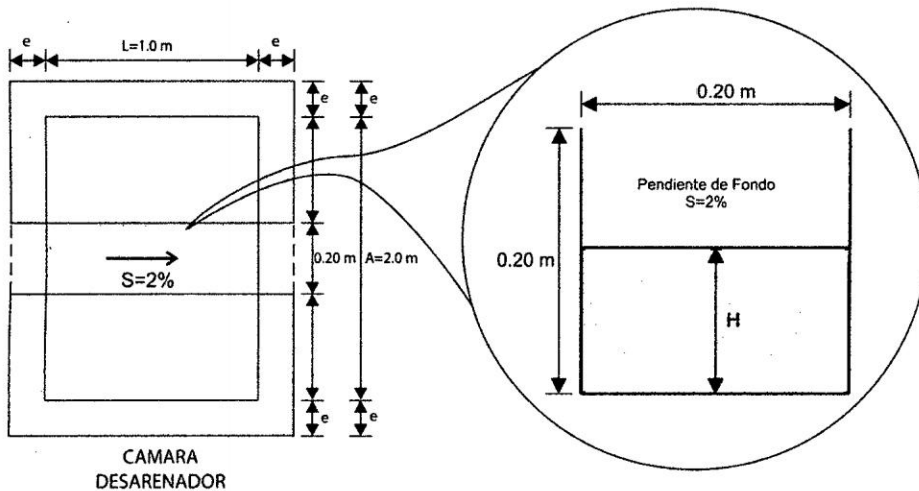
Vista en planta y Sección final de la cámara Desarenador. Fuente:
